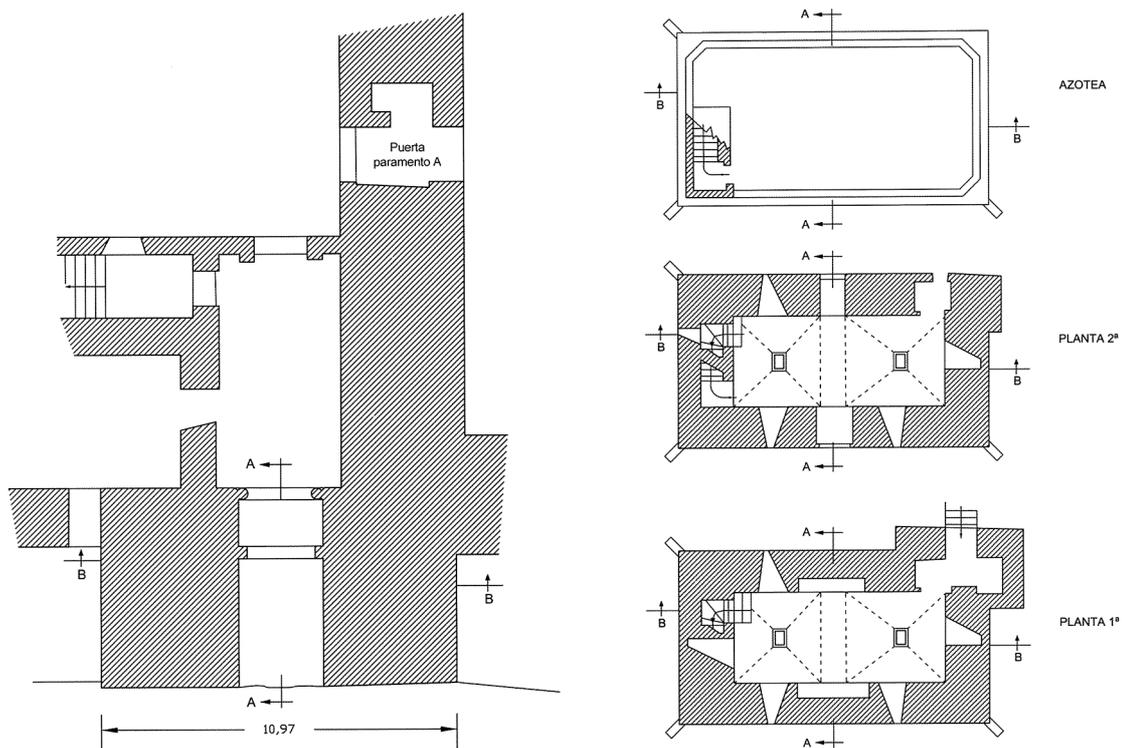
Planta de los accesos al castillo y de las plantas primera, segunda y azotea.
